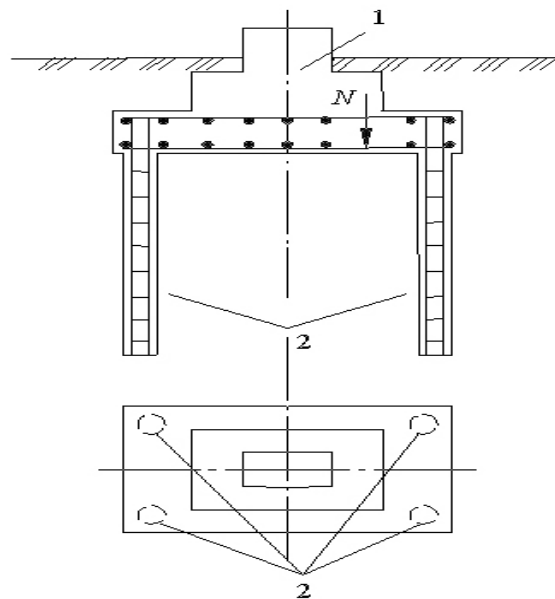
Схема фундаменту з анкерами: 1 – фундамент; 2 – анкери
